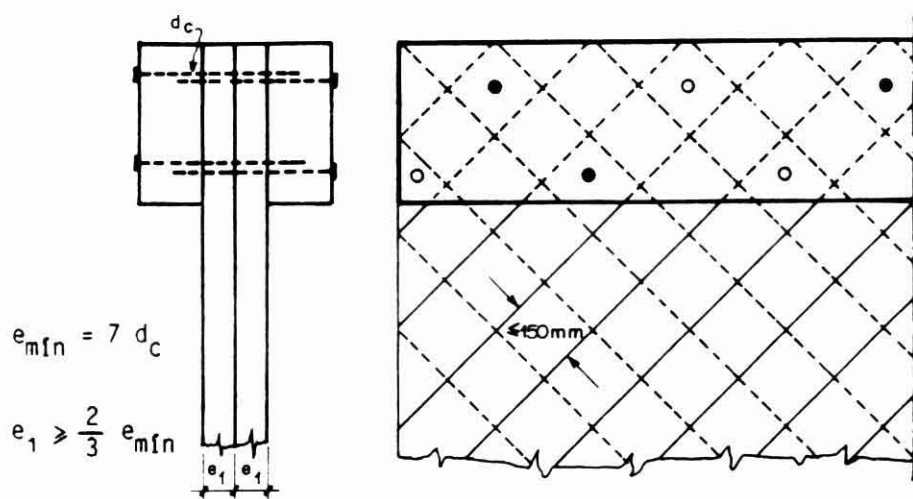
Clavado en vigas compuestas de alma llena.
